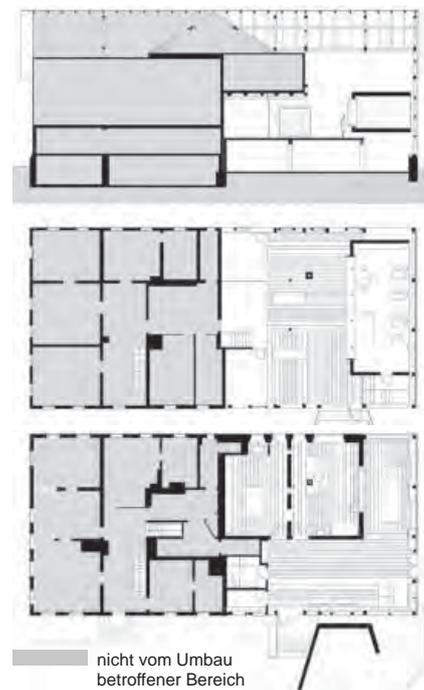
, Längsschnitt, Grundriss Ebene +1, Grundriss Ebene 0 (v.o.n.u.)
